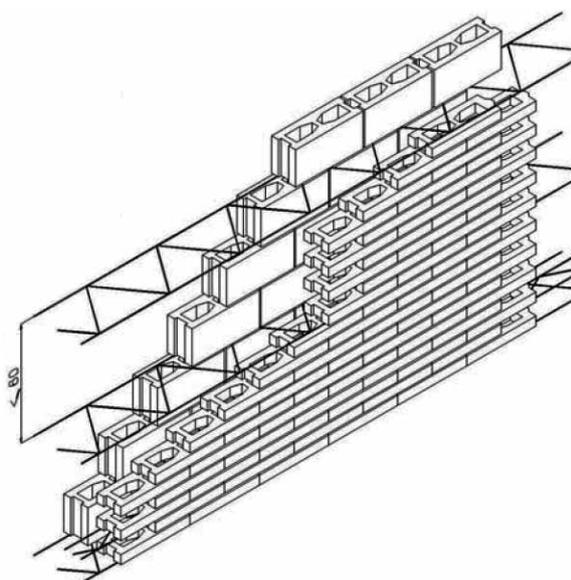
Muro capuchino de fábrica armada con armadura prefabricada de tendel y con hoja exterior de ladrillo alargado y hoja interior de bloque de hormigón hueco.
